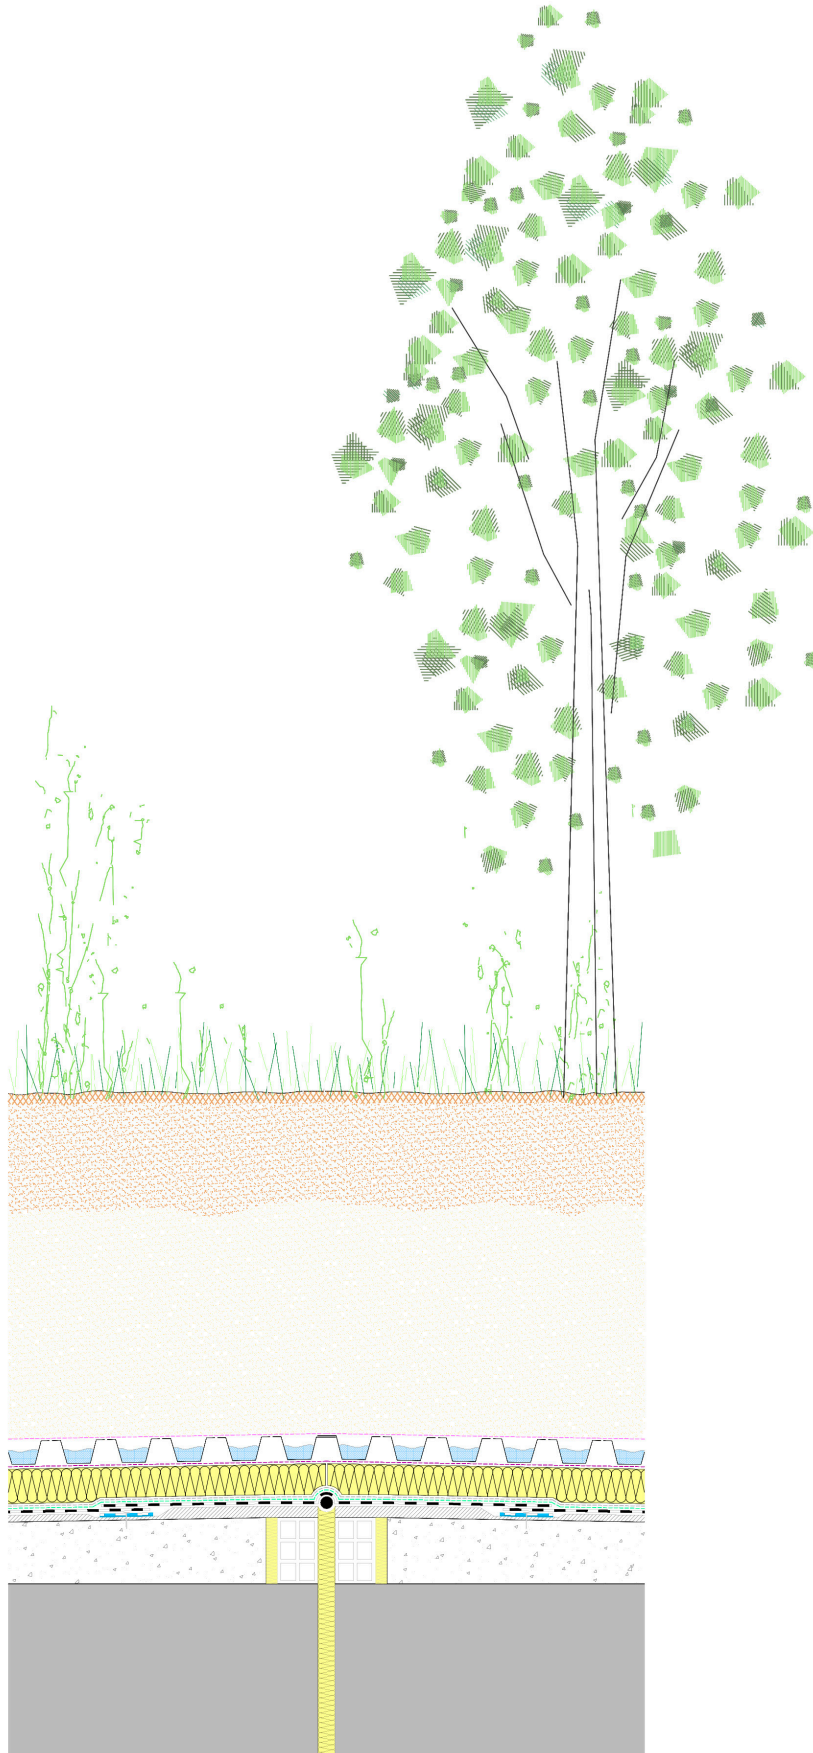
Junta de dilatación estructural en cubierta ajardinada intensiva invertida.
